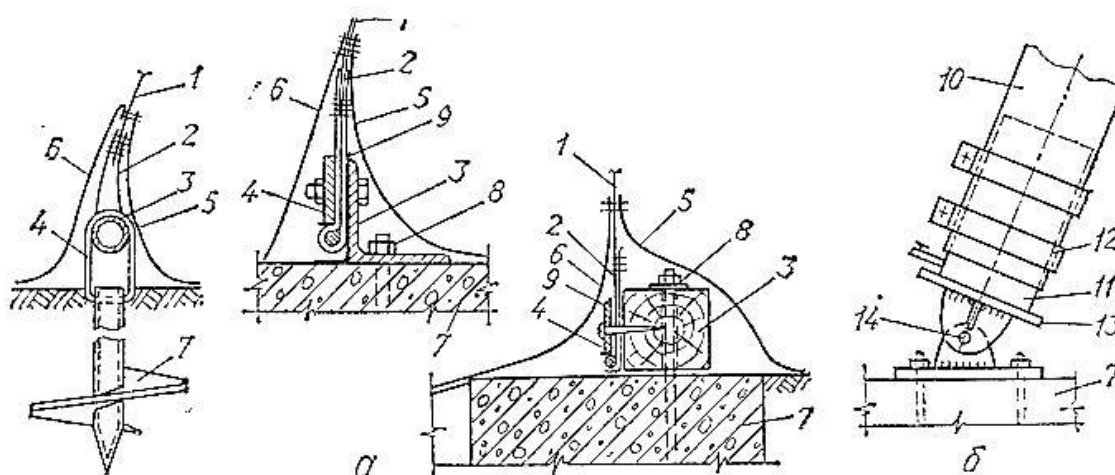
Крепление пневмоконструкций к фундаменту:
